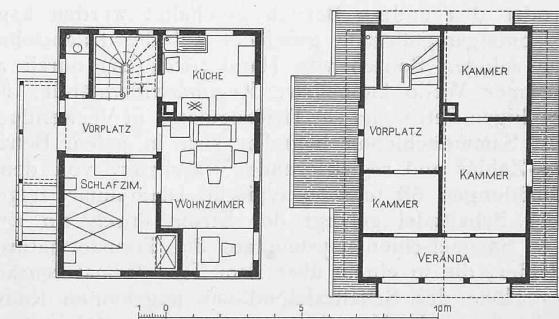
Grundrisse vom Erdgeschoss und Dachstock zu Abb. 1. Maßstab 1:250.
